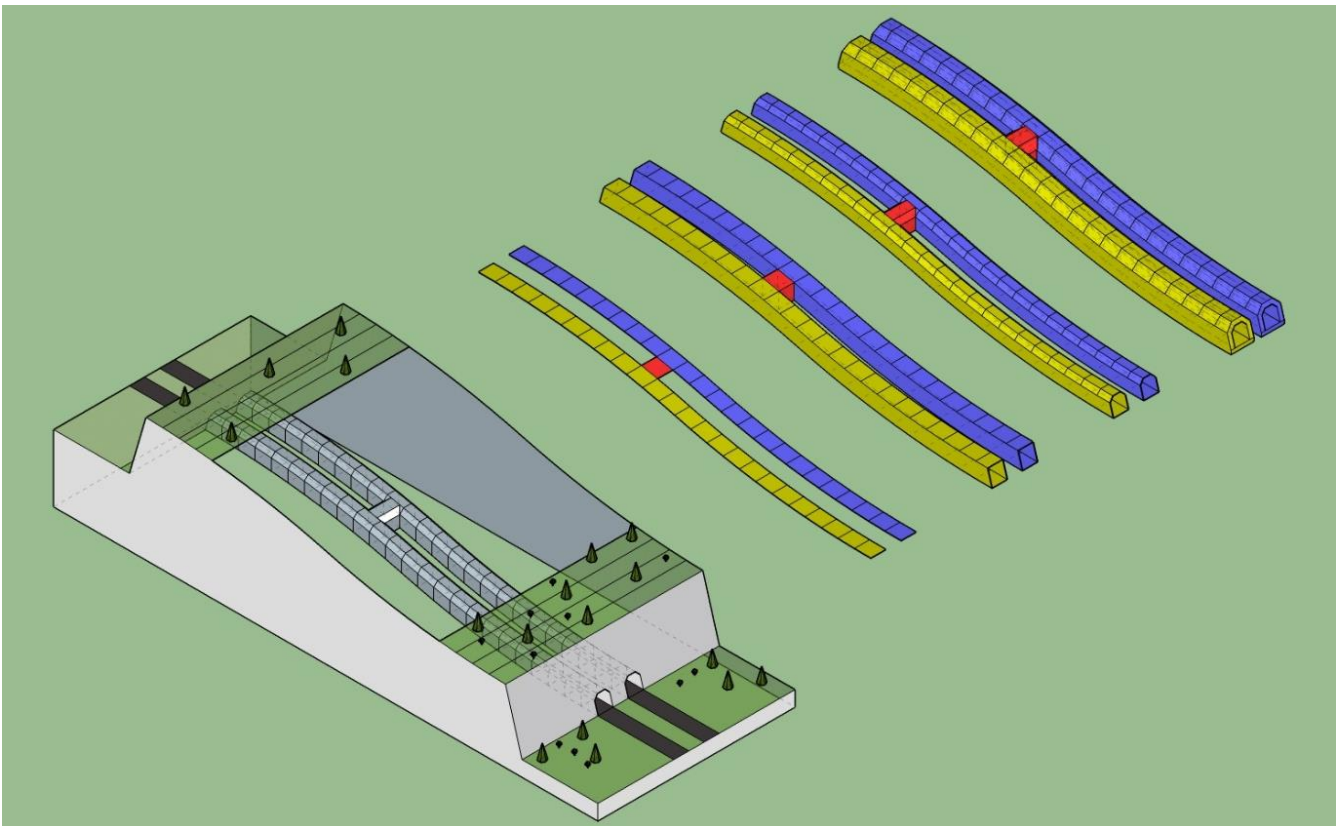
Tunneli-kohde voi koostua TunnelinOsista, TunnelinRakenteellisistaElementeistä ja TunnelinVarusteista. Esimerkkikuvassa TunnelinOsa on Tunnelin sisäpinnan rajaama kokonaisuus, TunnelinRakenteellisiaElementtejä ovat tunnelin kuori ja tunnelin pilari, TunnelinVarusteita ovat ilmanvaihtotuulettimet.
